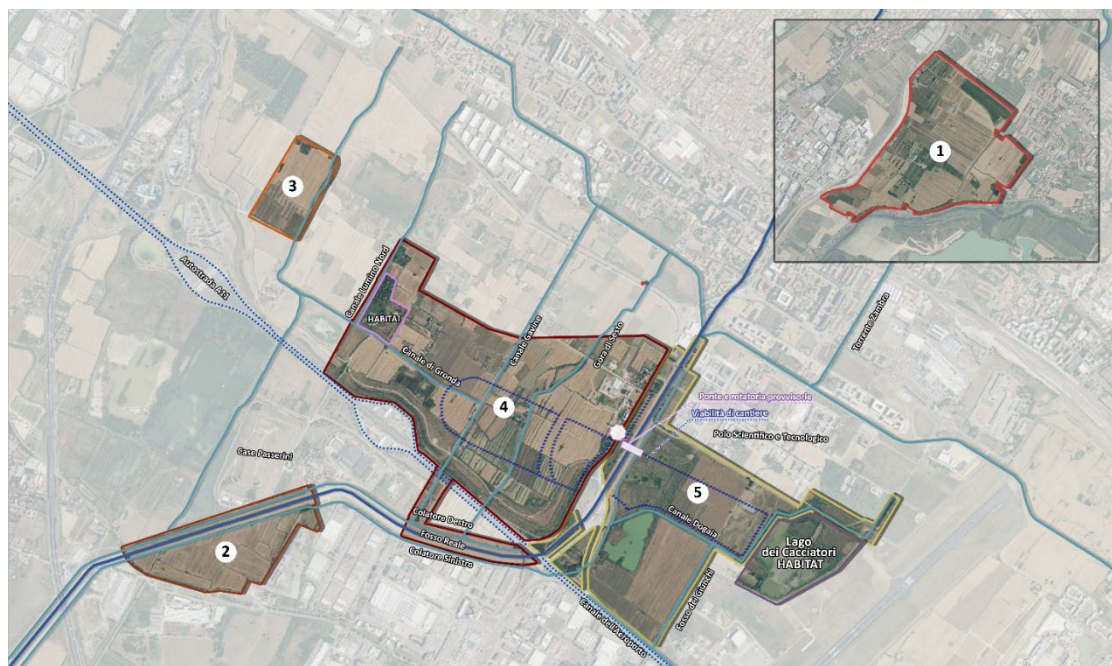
Planimetria di cantierizzazione: viabilità di cantiere
